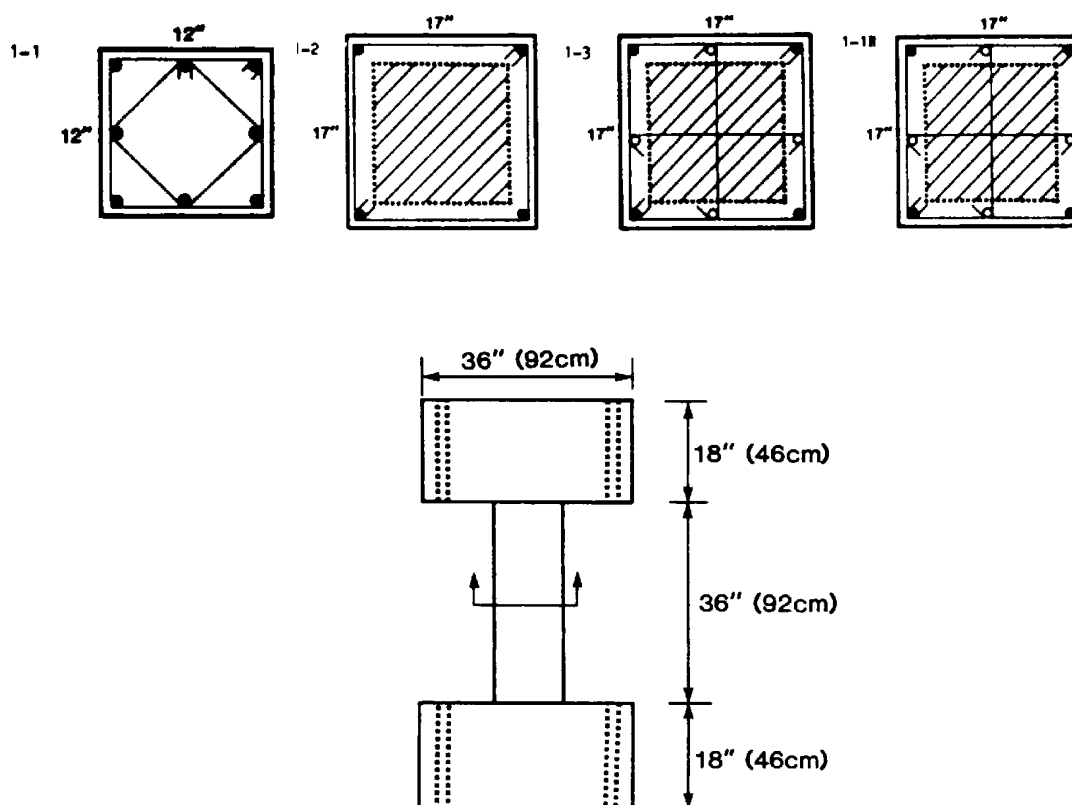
Detalhe dos modelos ensaiados (BETT et al., 1988)
